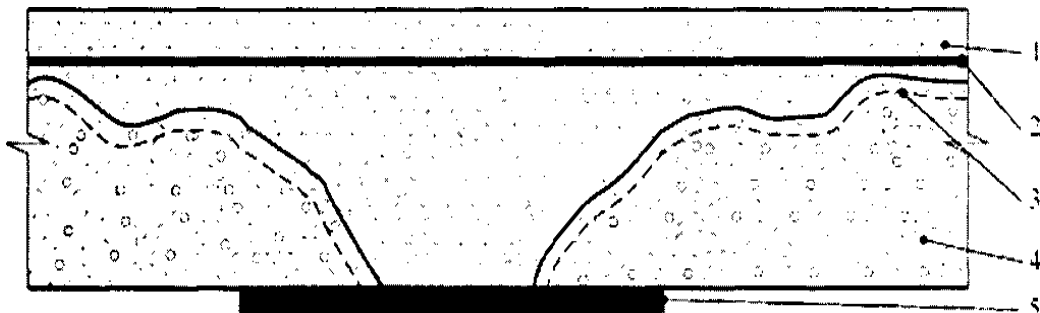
Відновлення конструкцій залежно руйнування поверхневого шару бетону. де: 1 — відновлений шар бетону; 2 — арматура; 3 — перехідний шар; 4 — відновлювана конструкція; 5 — опалубка.
